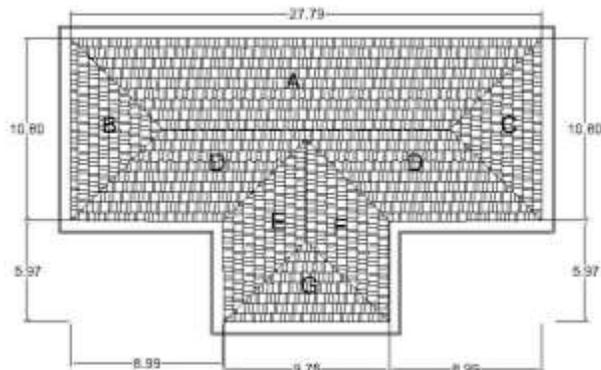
Kondisi Bubungan Genting, Overstek, dan Talang Dak Beton
